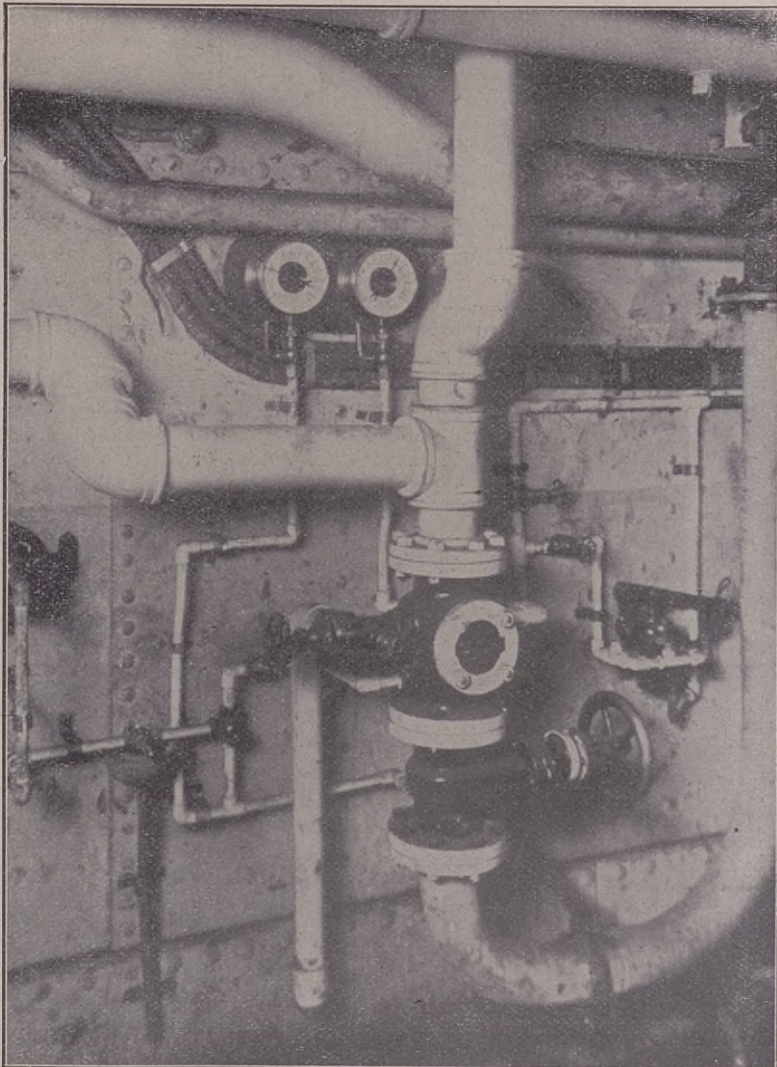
Betriebsanlage für die Sprinkler-Brausen
